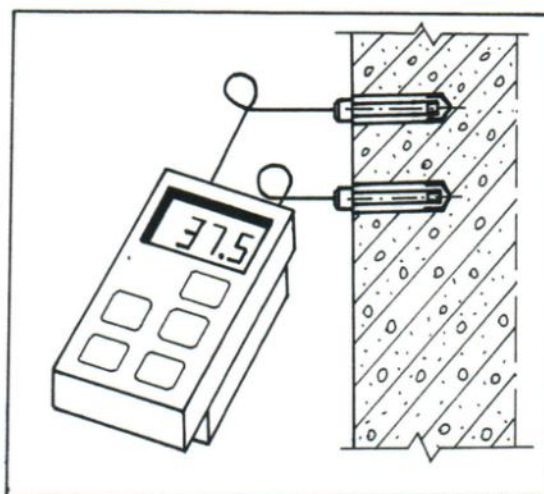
Aparat pentru msurarea umidității în beton (firma GERMANN INSTRUMENTS)
